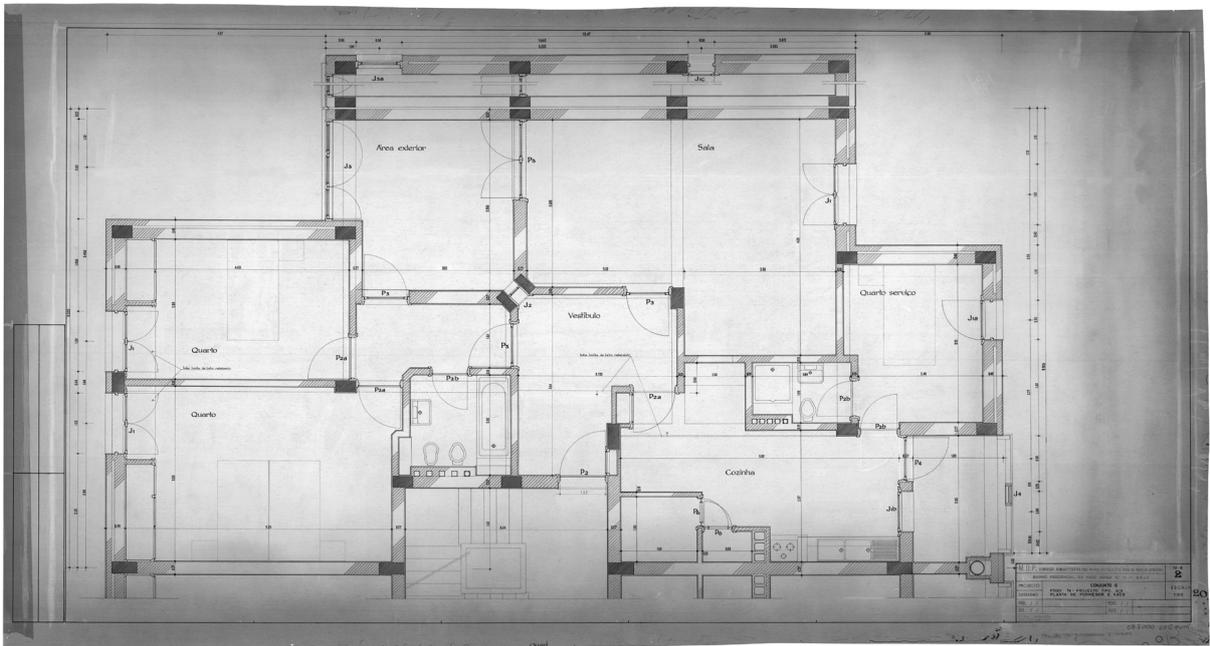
Projeto: fogo T4 – projecto tipo G12, planta de pormenor e vãos
